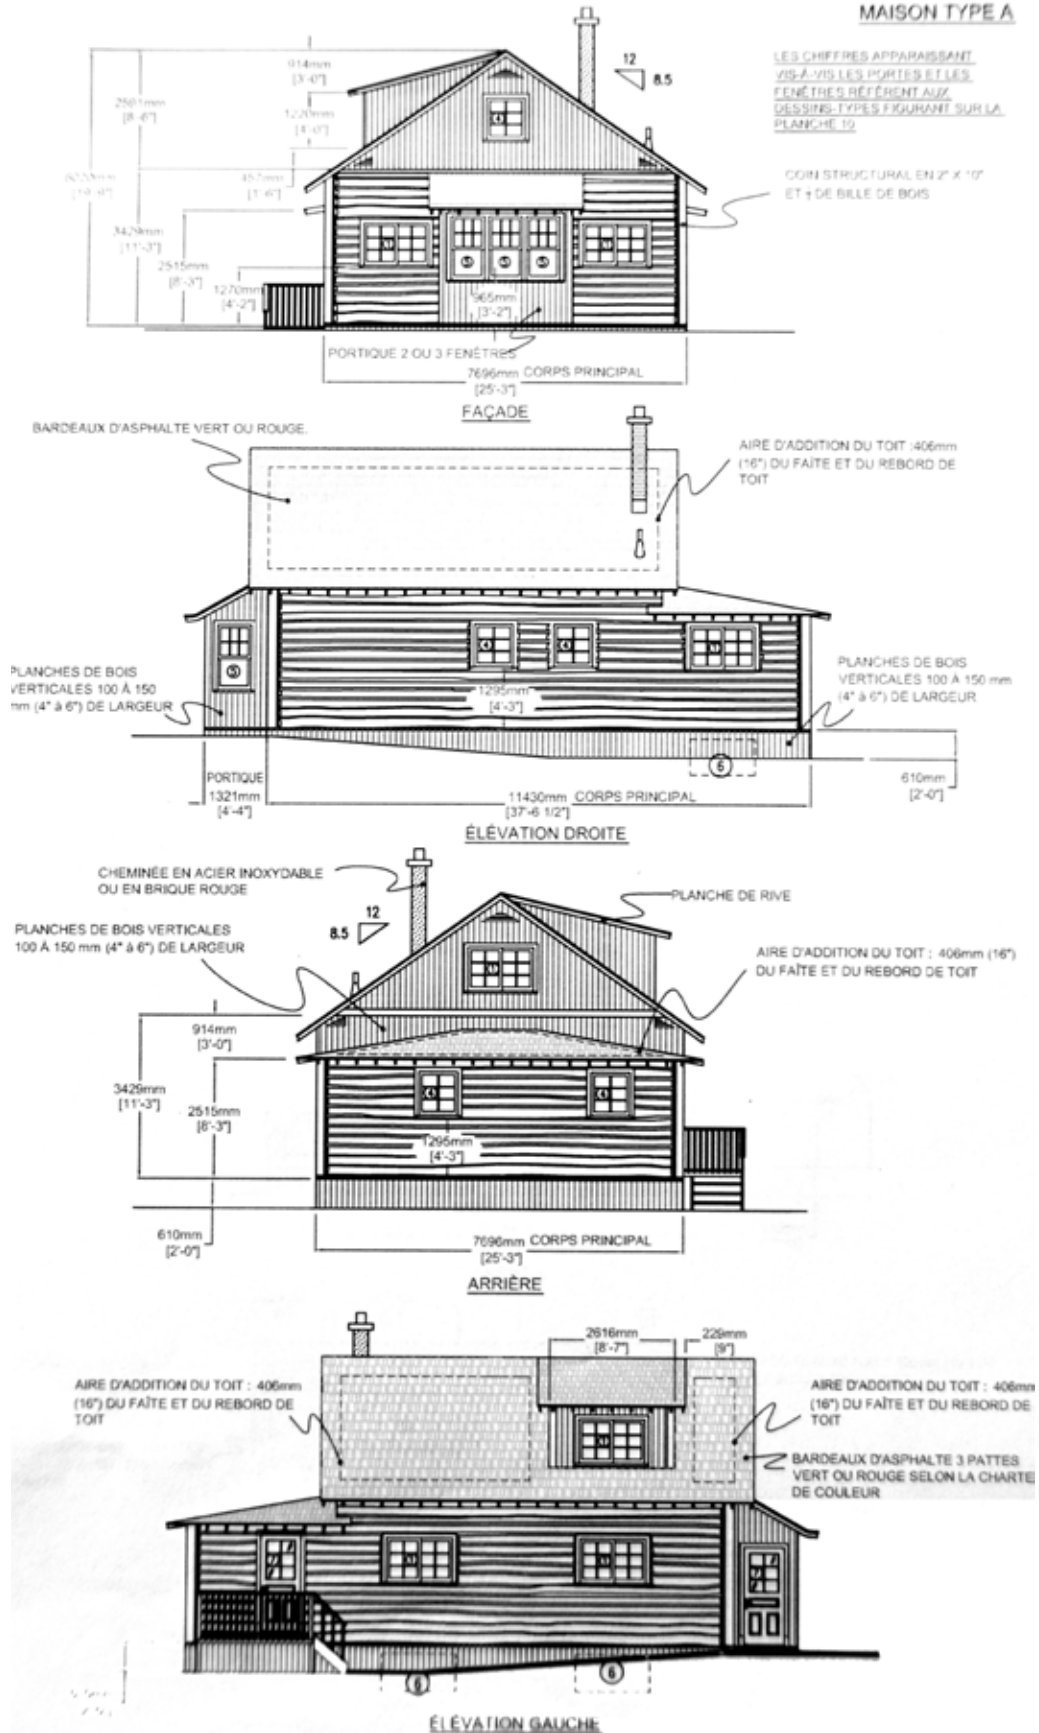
Élévations de la maison de type A, caractérisée par un toit à deux versants avec pignon en façade. La façade est caractérisée par un portique et une fenêtre de chaque côté. À deux étages, elles possèdent une lucarne. Noter également l'annexe à l'arrière.
